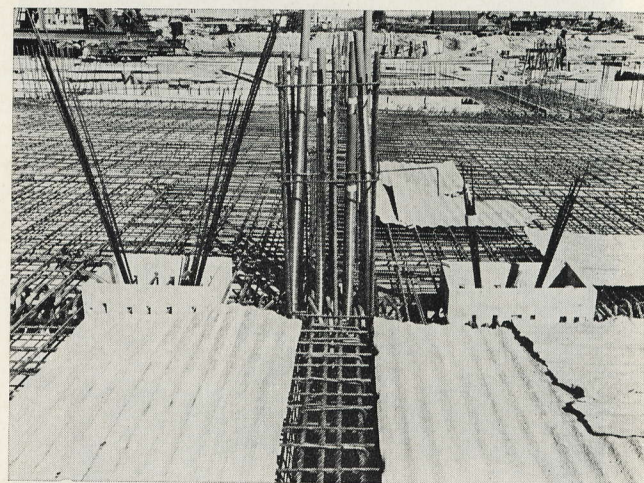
Ferrailage du plancher haut du rez-de-chaussée. Au premier plan l'arrivée des deux doubles câbles d'ancrage Est. Les boîtes réservent l'emplacement du bloc préfabriqué dans lequel seront coulés les cônes d'ancrage. Dans le poteau central : faisceau des câbles verticaux dont nous avons vu le départ au sous-sol (fig. 8). On aperçoit également dans le ferrailage du plancher les câbles horizontaux de précontrainte.
